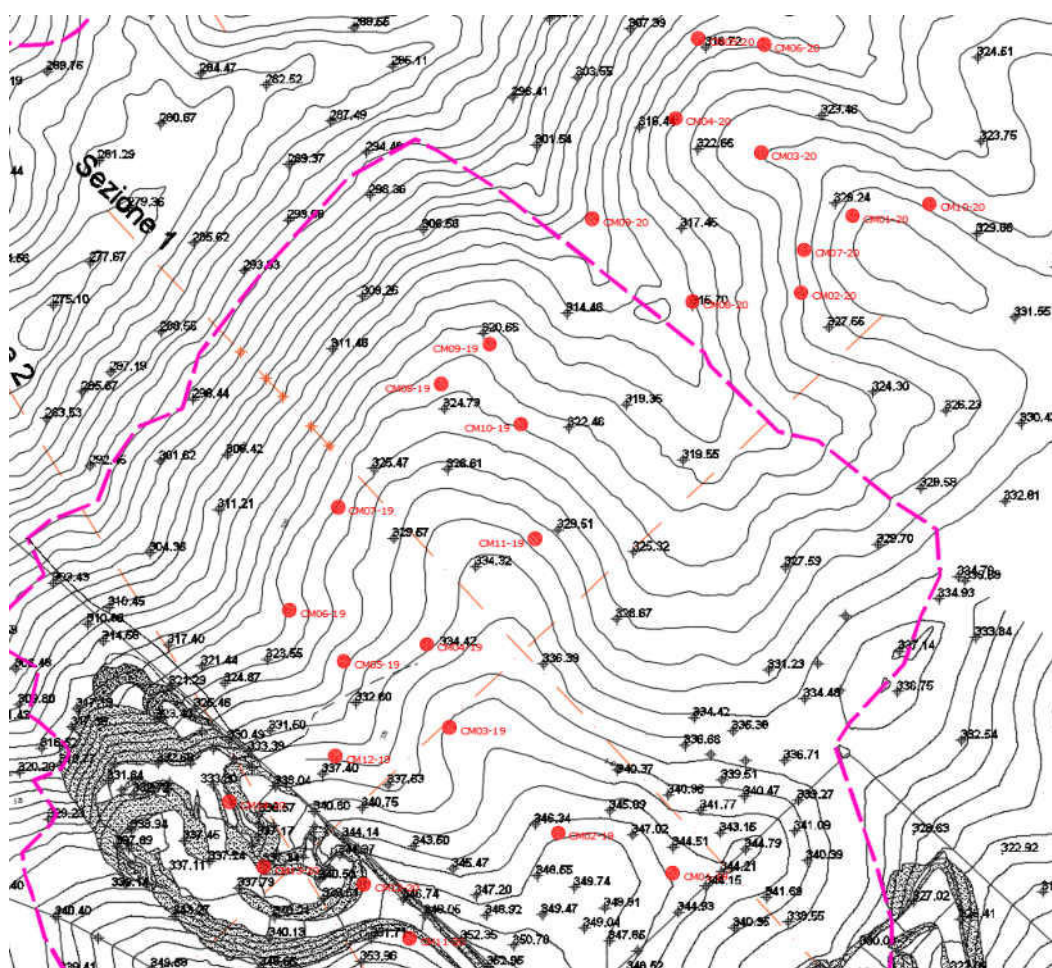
planimetria di stato attuale con indicazione dei campionamenti
